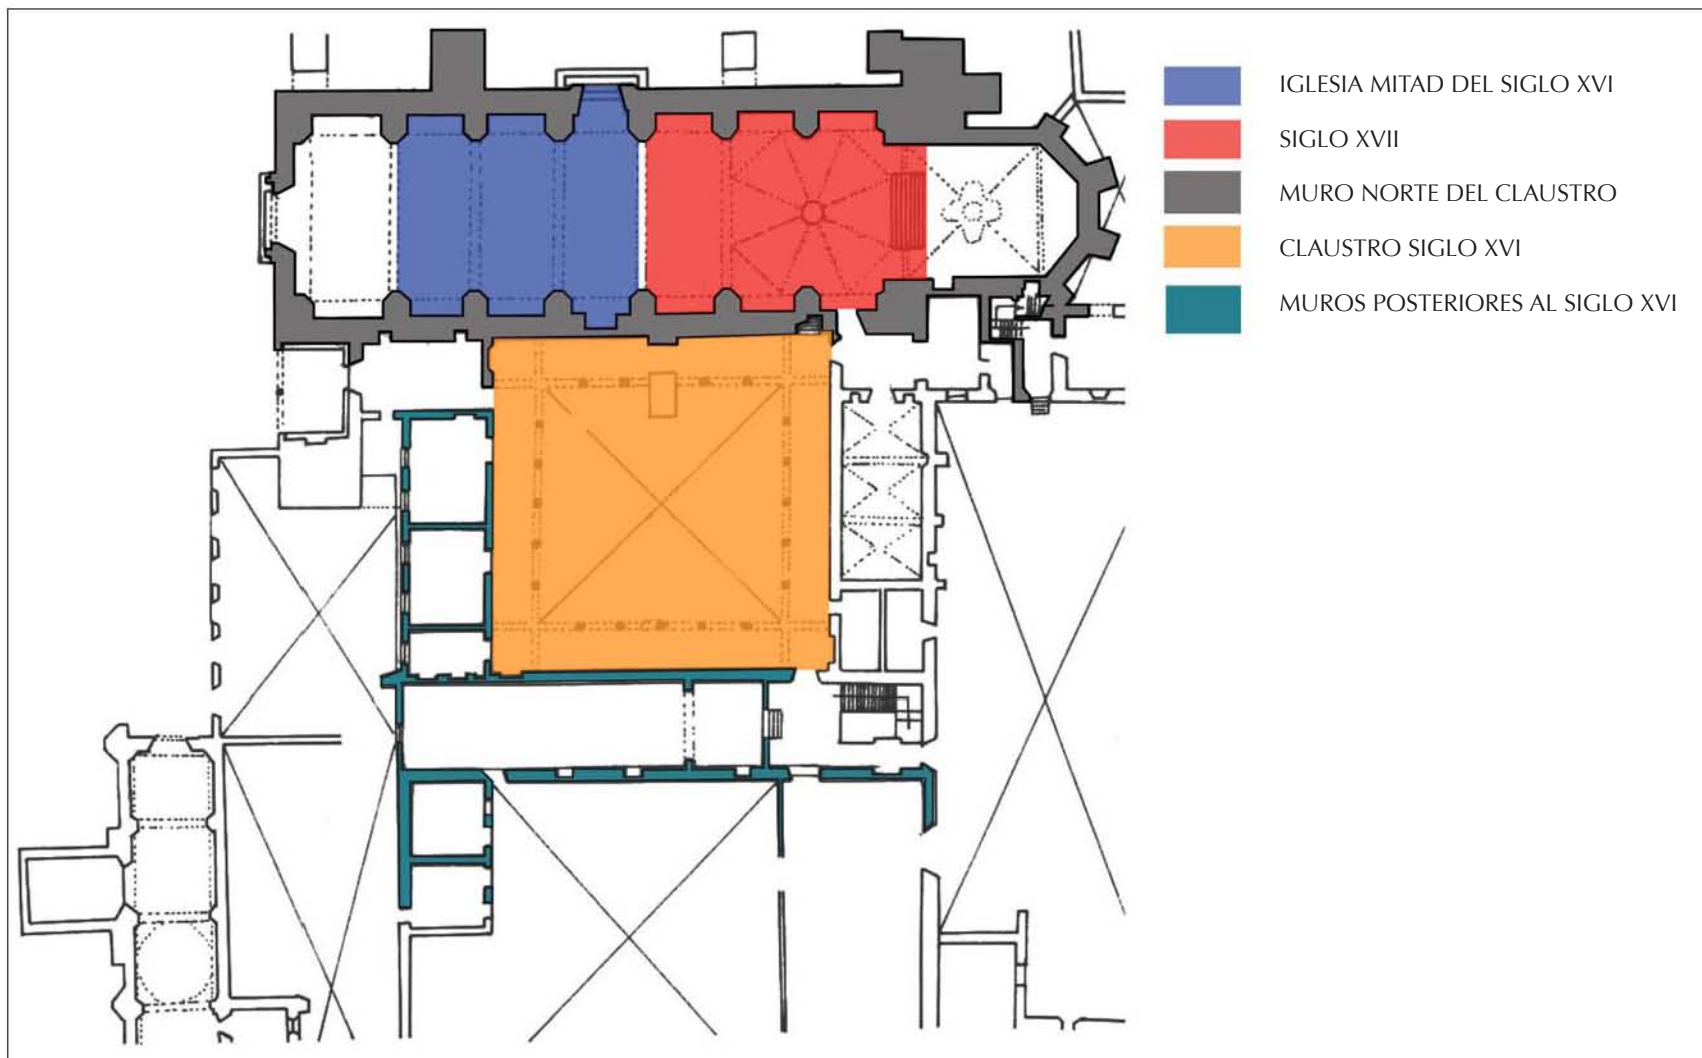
Planta de conjunto modificada, en la que se aprecian los anchos muros característicos de las construcciones del XVI, como el claustro que se inició por el muro norte, y los muros de etapas posteriores que son más delgados. Fuente: INAH, *Catálogo Nacional. Monumentos Históricos Muebles, Xochimilco, DF.*, DDF-INAH, México, 1987, p. 69.
